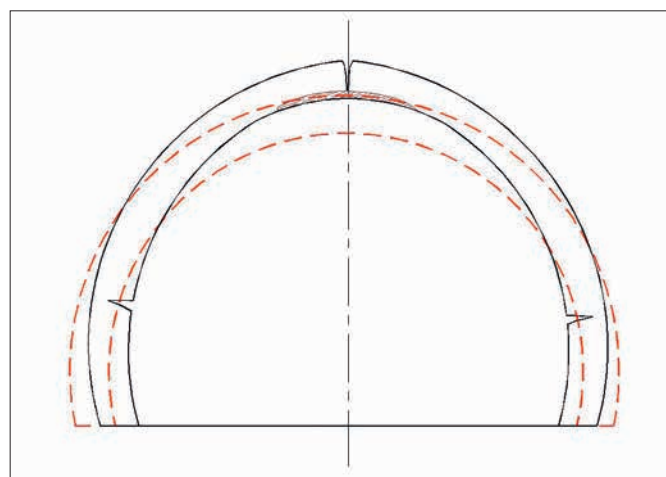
schéma simplifié des déformations du revêtement subissant un pincement (les zones hachurées indiquent les zones en compression, par rapport aux zones en extensions -fissures-)
